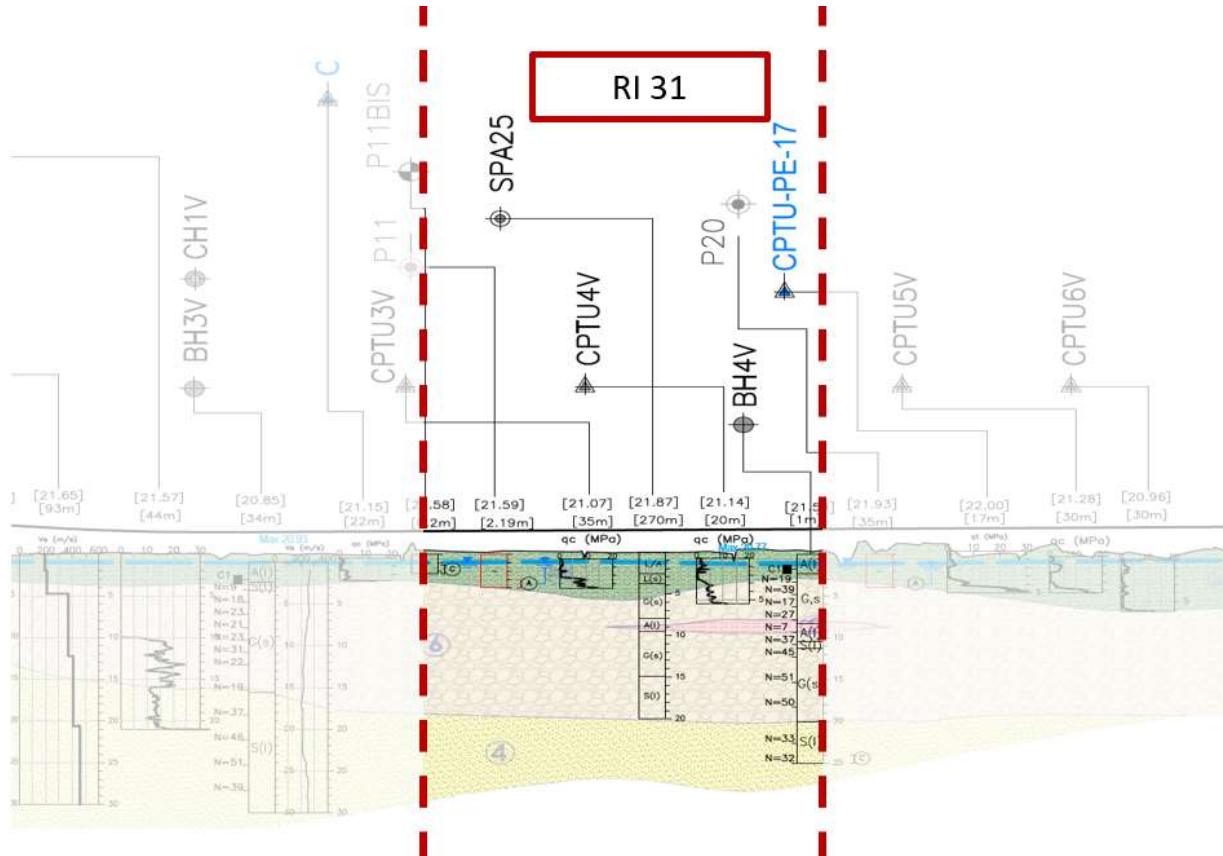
Profilo Geotecnico Rilevato RI31, estratto dal Profilo Geotecnico Generale (Doc. Rif. [3])
